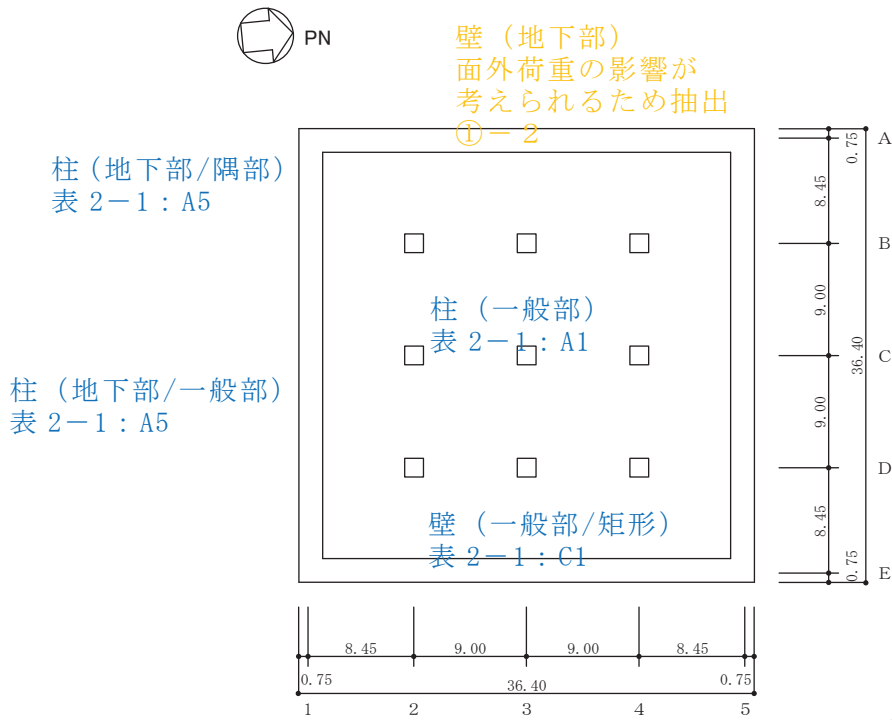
(2) 緊急時対策建屋の概略平面図 (0. P. 57. 3m) (単位 : m)
